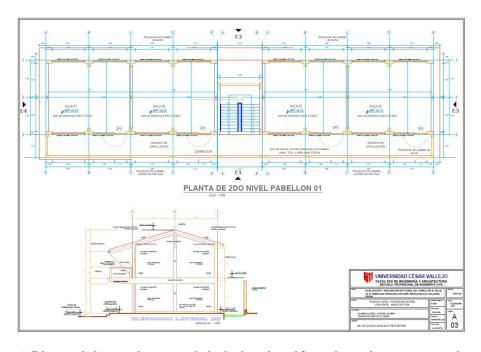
Plano del estado actual de la institución educativa – segunda planta
